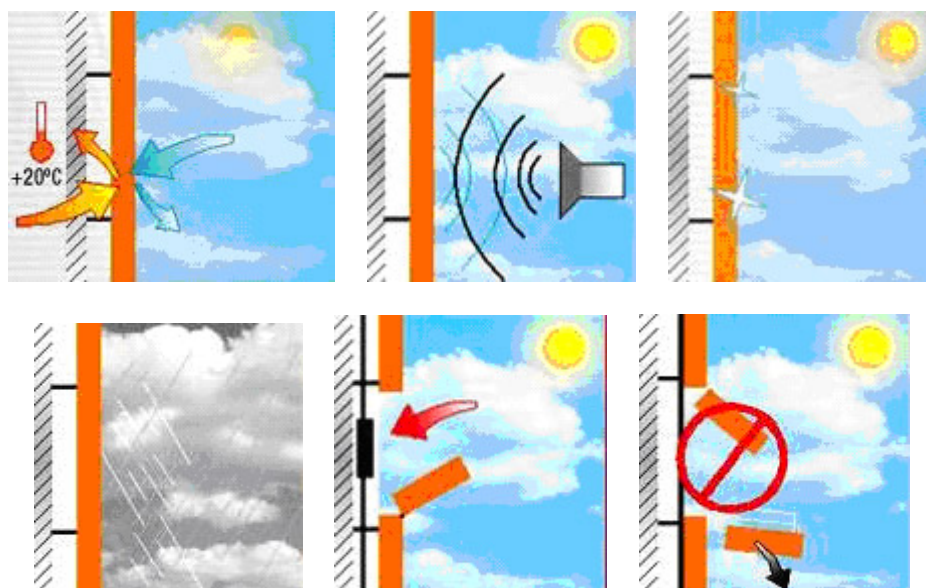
Vantagens da fachada ventilada: protecção térmica, acústica, acabamento tratado, impermeabilidade, fácil substituição, segurança contra quedas [42]
